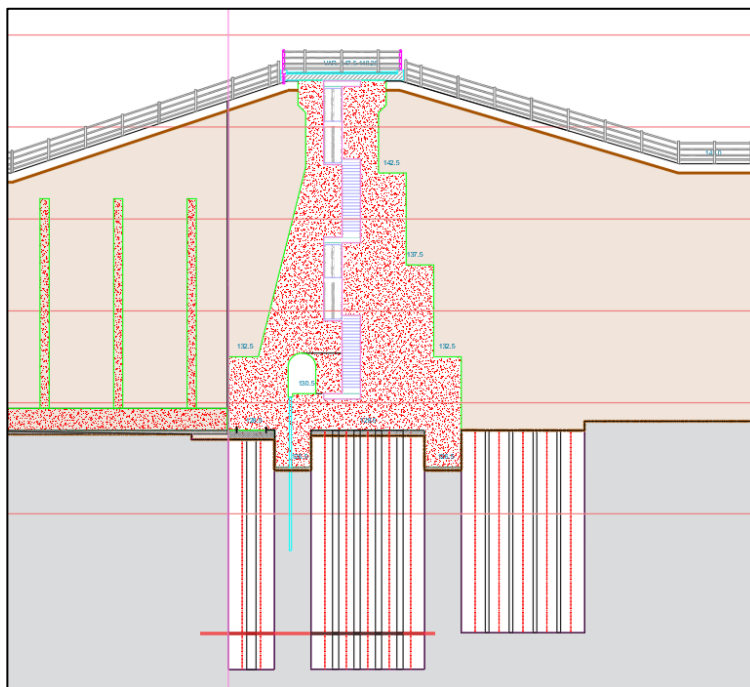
Sezione trasversale concio di collegamento lato est della cassa
